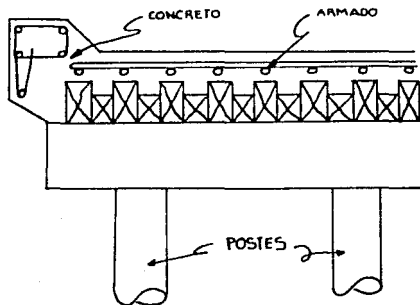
PISO COMPUESTO DE MADERA Y CONCRETO.
